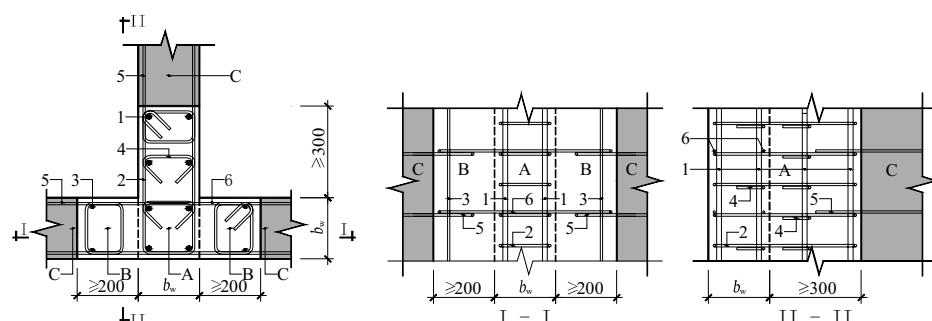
钢筋采取机械锚固措施构造示意
